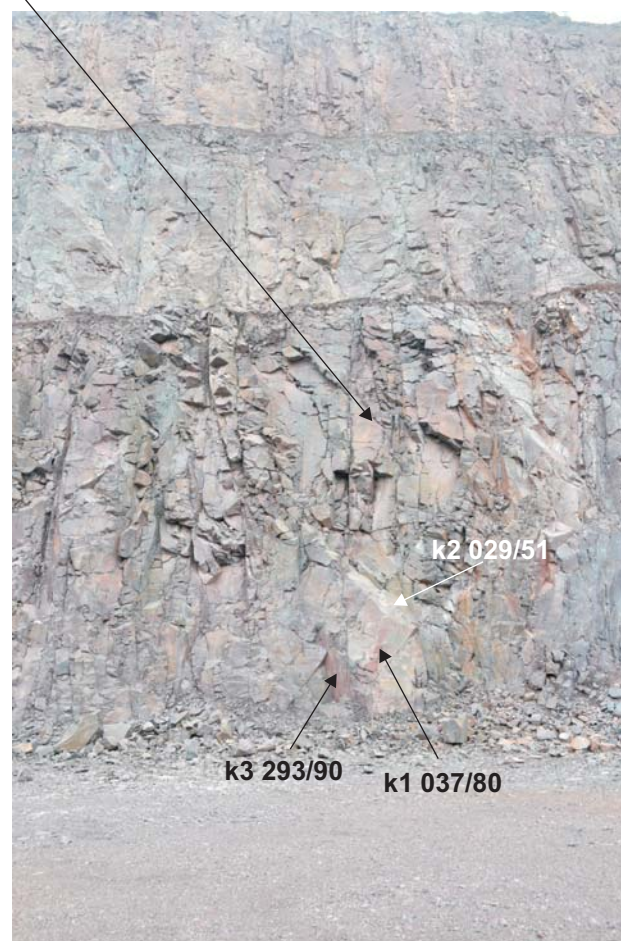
Tagebau 10.2017; Blick nach Südwesten auf die geplante Erweiterungsfläche
